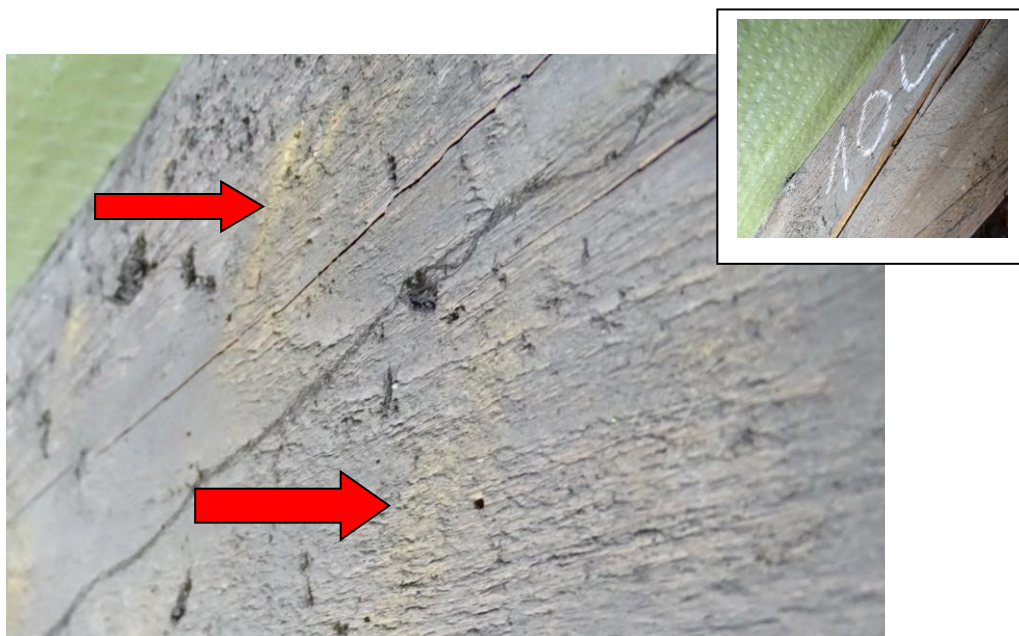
Zacieki na elementach drewnianych konstrukcji dachu
